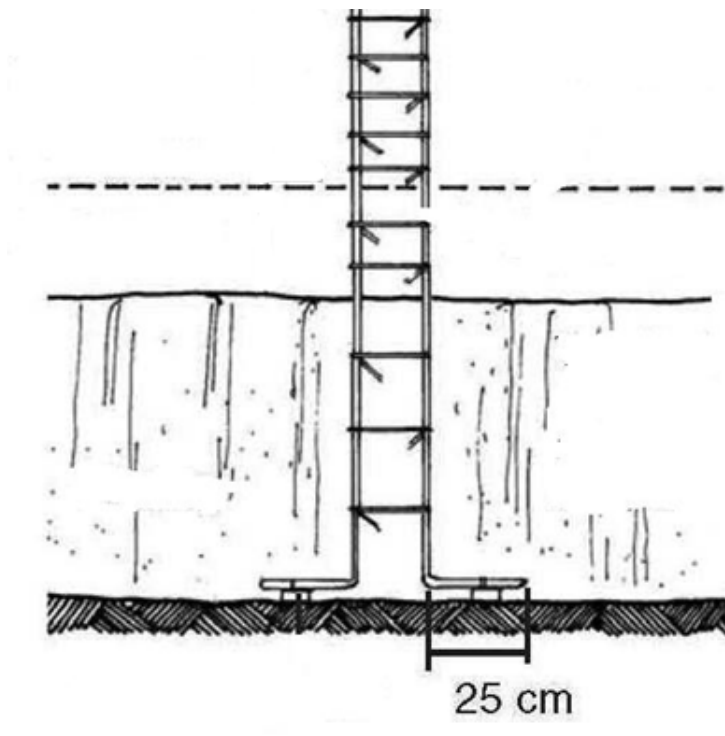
Anclaje de las barras longitudinales del los pilares en la fundación (Totten, 2010)
